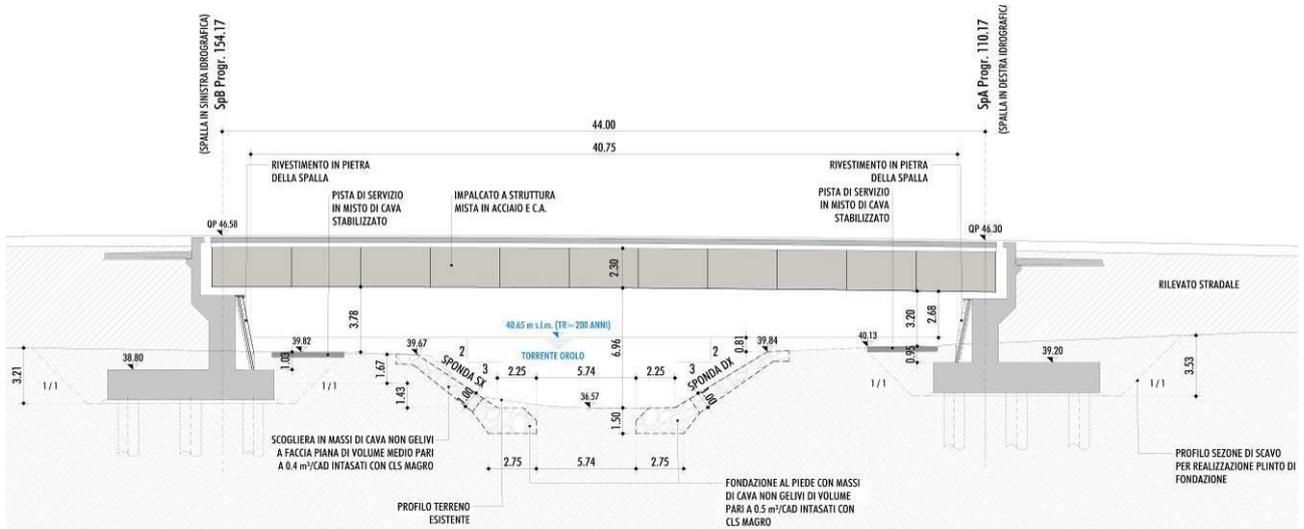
SEZIONE LONGITUDINALE PONTE SUL TORRENTE OROLO
